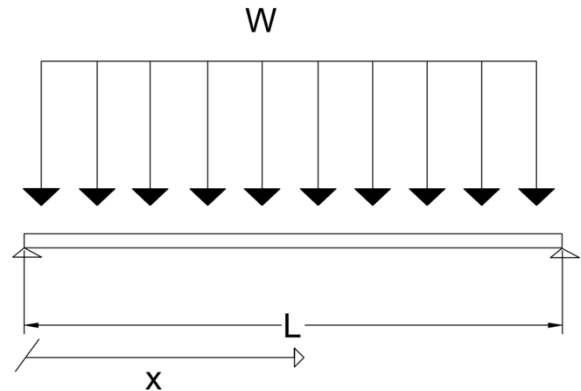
Viga simplemente apoyada con carga distribuida. Fuente: Obtenido de Vargas (2013).
